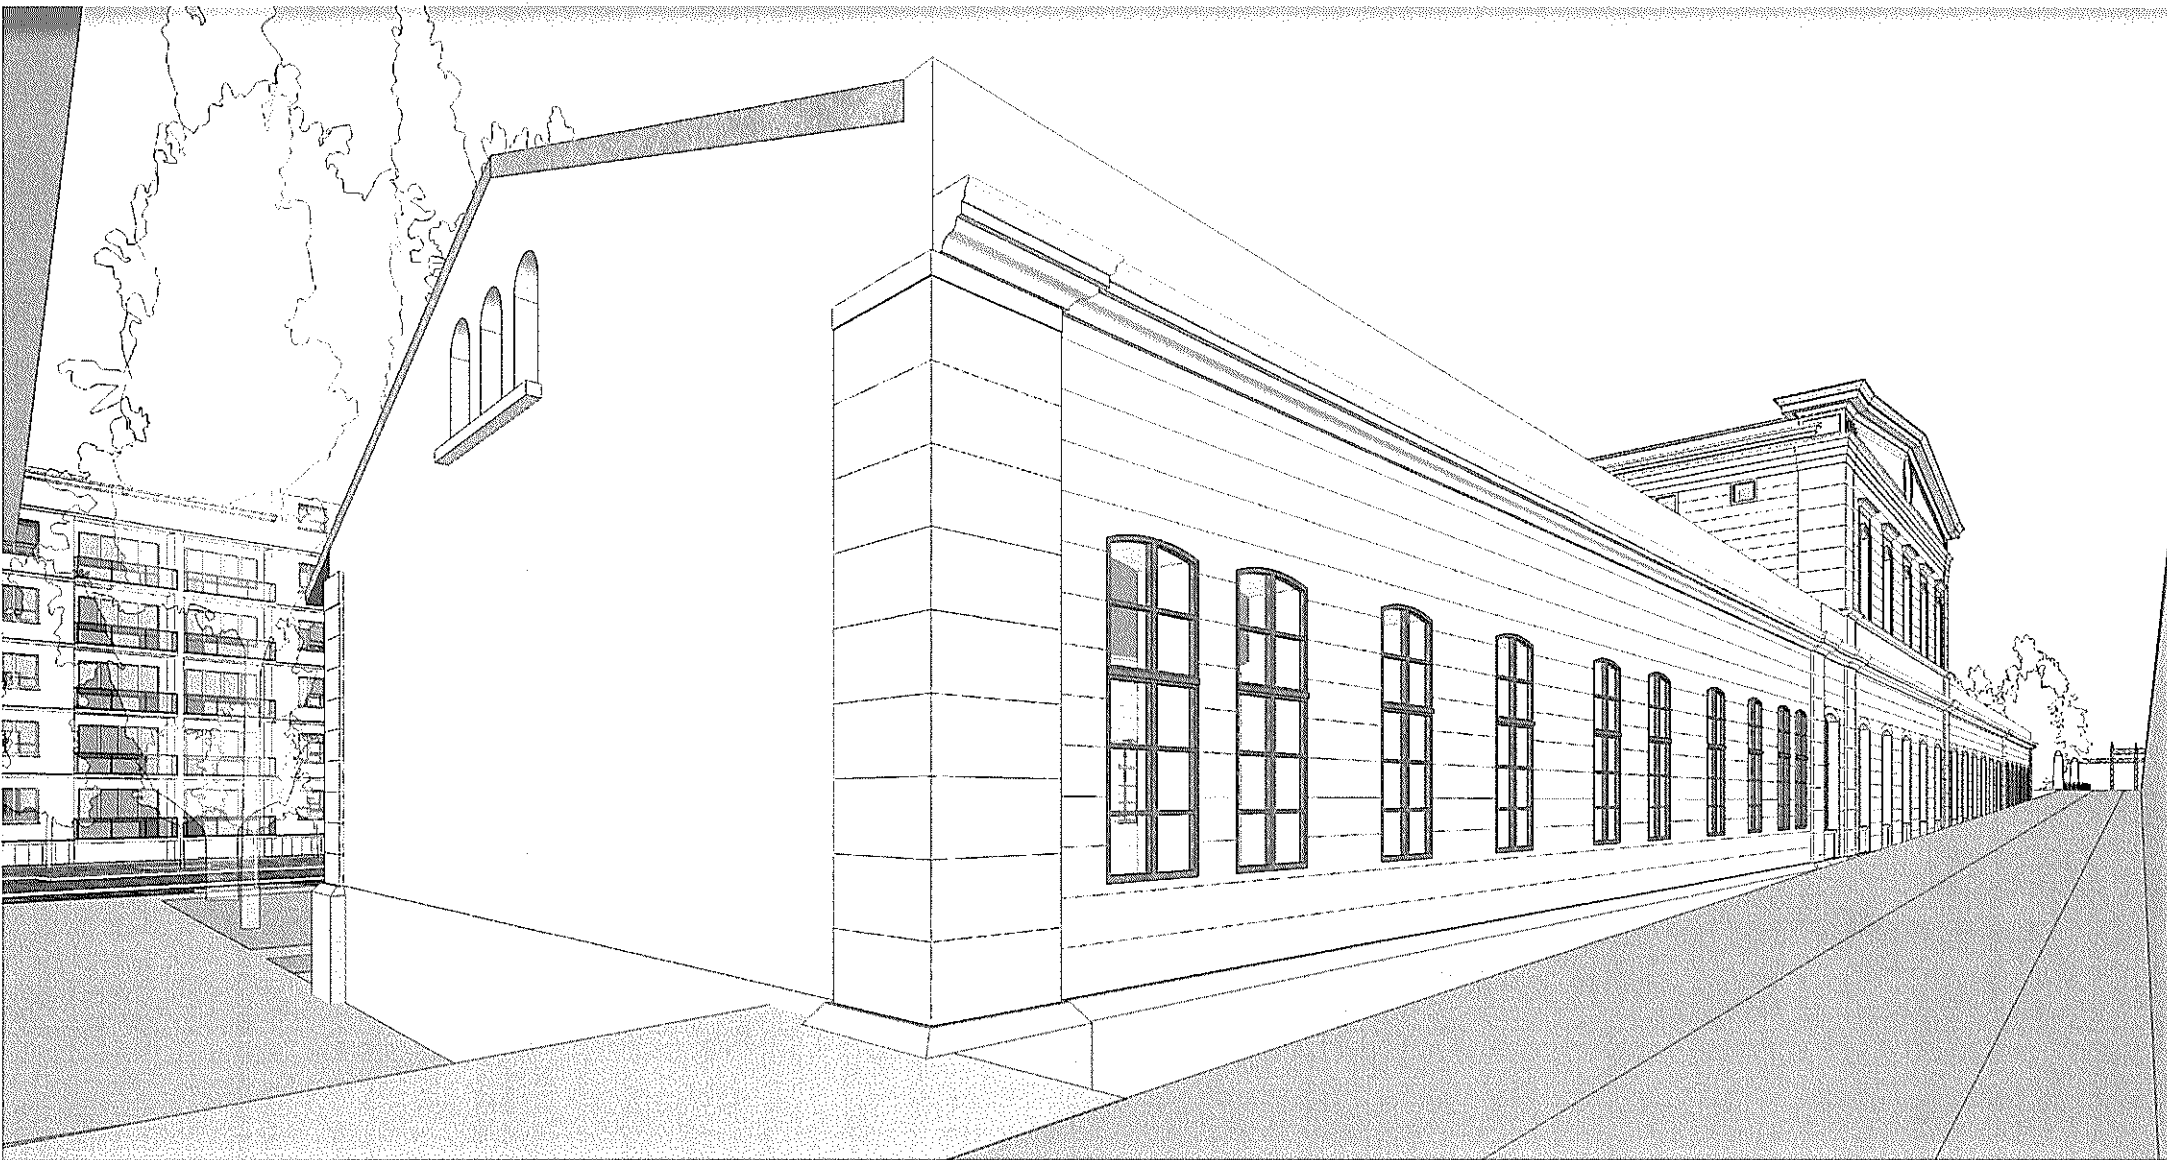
Widok z zabytkowej rampy kolejowej w kierunku zachodnim
